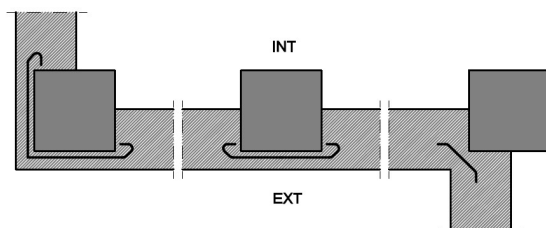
Ejemplo de encuentro de la fachada con los pilares
